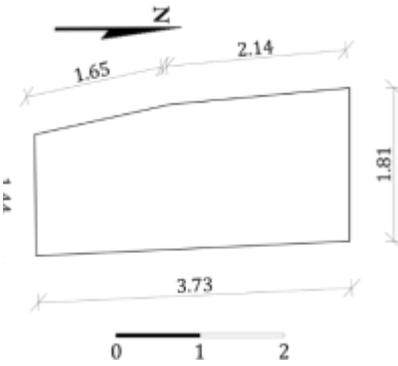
مسقط أفقي لمنور الدهليز الغربي بخانقاة ببيرس الجاشنكير (عمل الباحثة)
